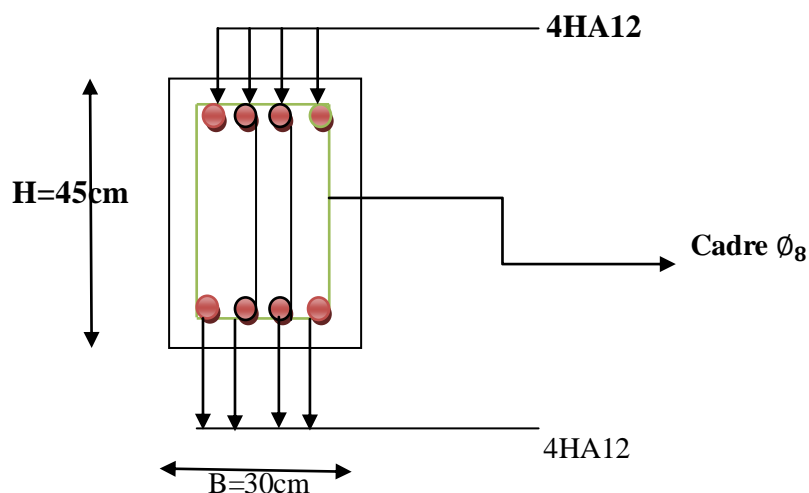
schéma de ferrailage de la poutre de chaînage.
